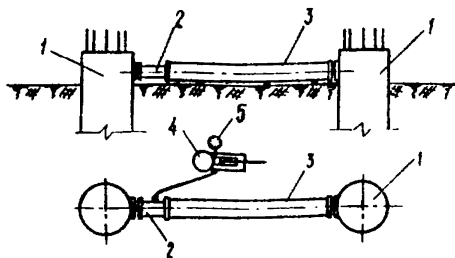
Схема испытания на горизонтальную нагрузку двух свай:
